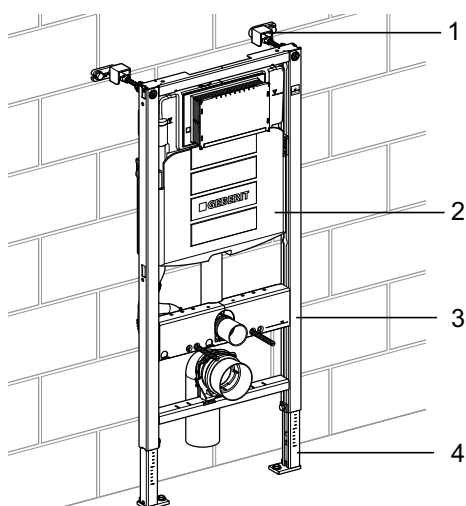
Aufbau Geberit Duofix Montageelement mit Geberit Sigma UP-Spülkasten
